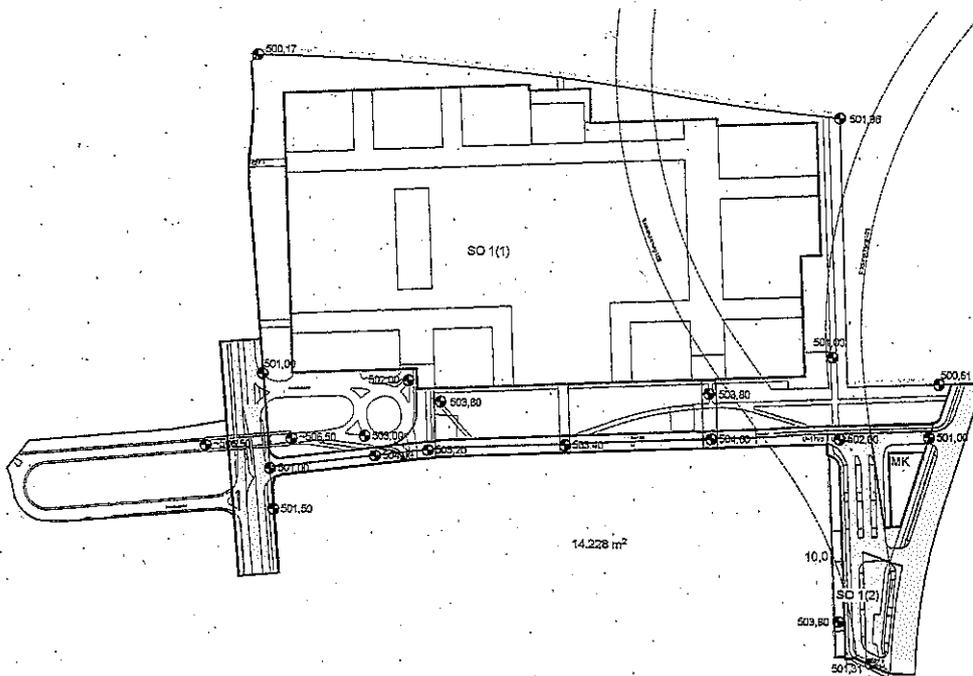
Höhenkotenplan - Kotenangaben in m ü. NN (maßstabslos)
